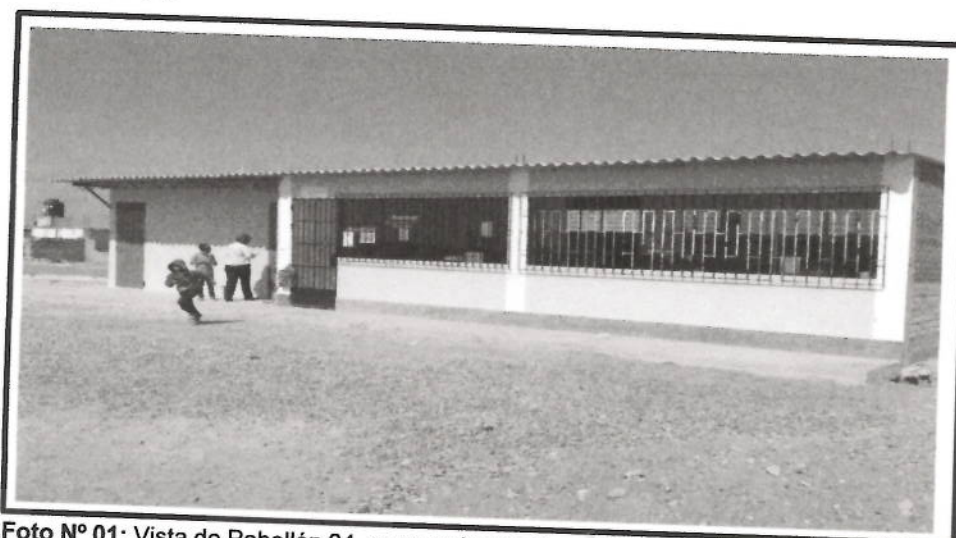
Vista de Pabellón 04, se aprecia que No existe espacio suficiente con respecto bloque 03
